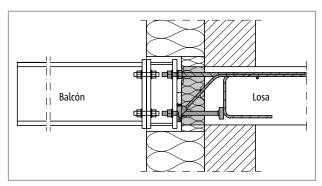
Schöck Isokorb® T tipo SK: Conexión del soporte de acero a un adaptador que compensa el espesor del aislamiento exterior
